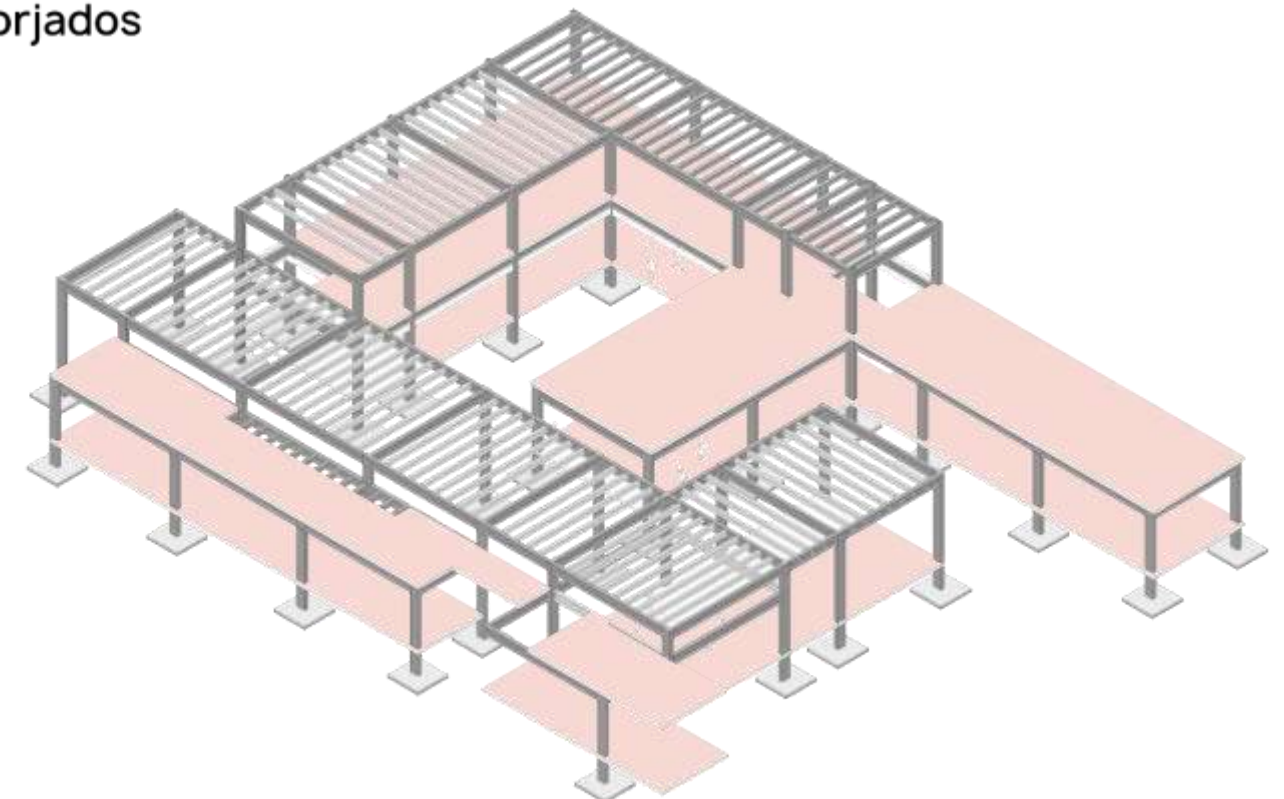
Seccionamiento Forjados Elaboración: propia. Fuente: propia
